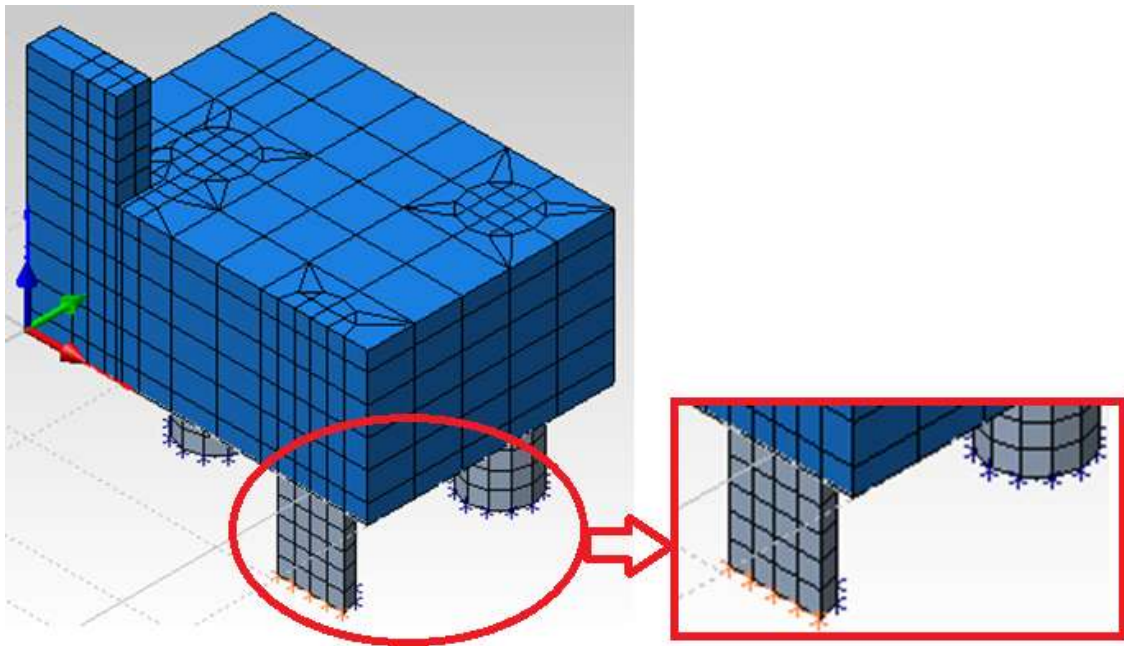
Bloco com apoio deformável. Carga no pilar.
